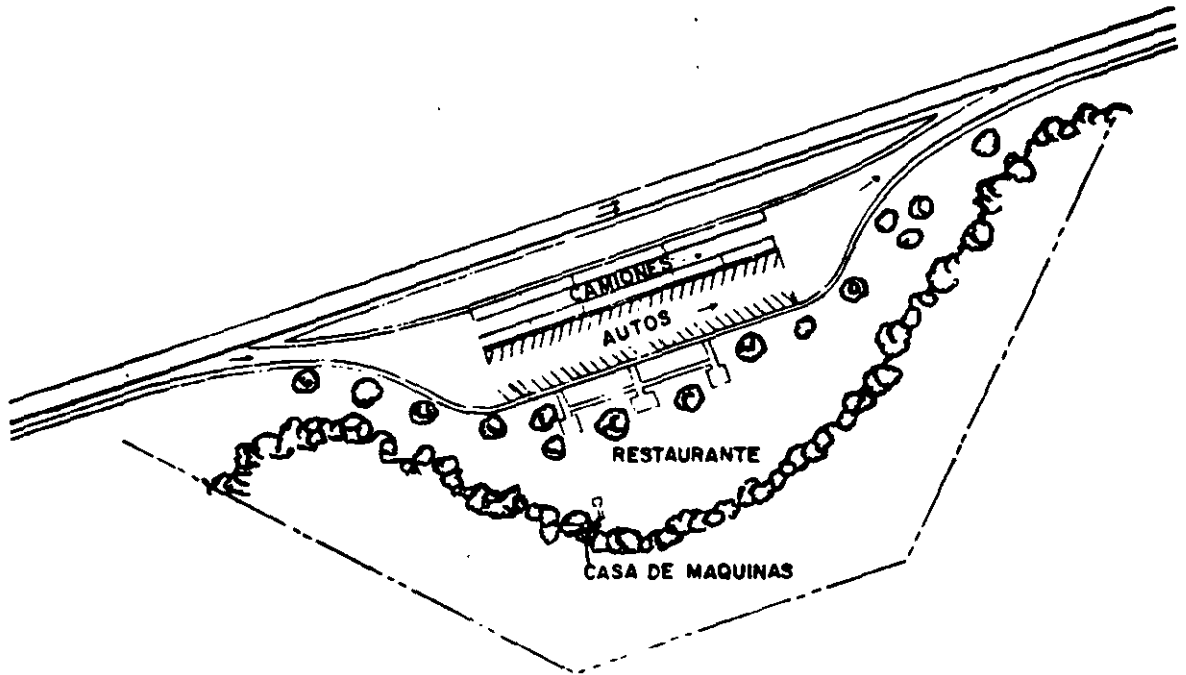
ZONA DE DESCANSO CON UNA GRAN AREA PAVIMENTADA PARA AUTOMOVILES Y CAMIONES
